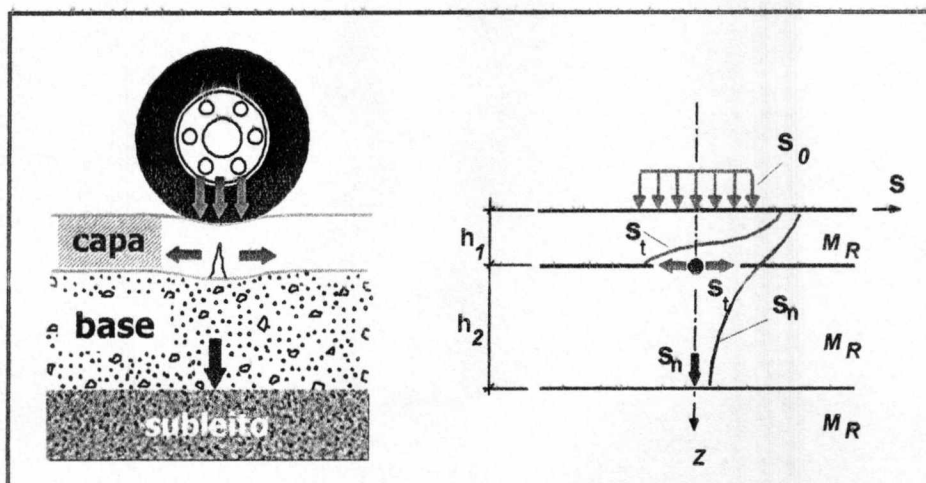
Ação da carga nos pontos críticos das camadas do pavimento
